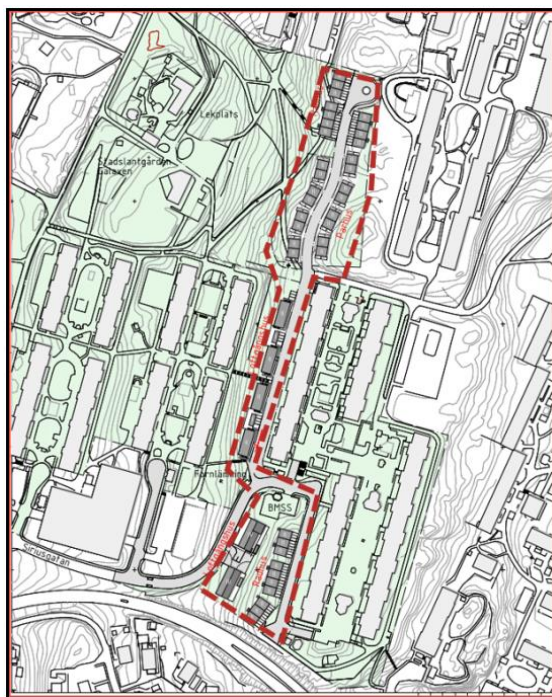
Aktuellt planområde inkl. befintlig och planerad bebyggelse.
